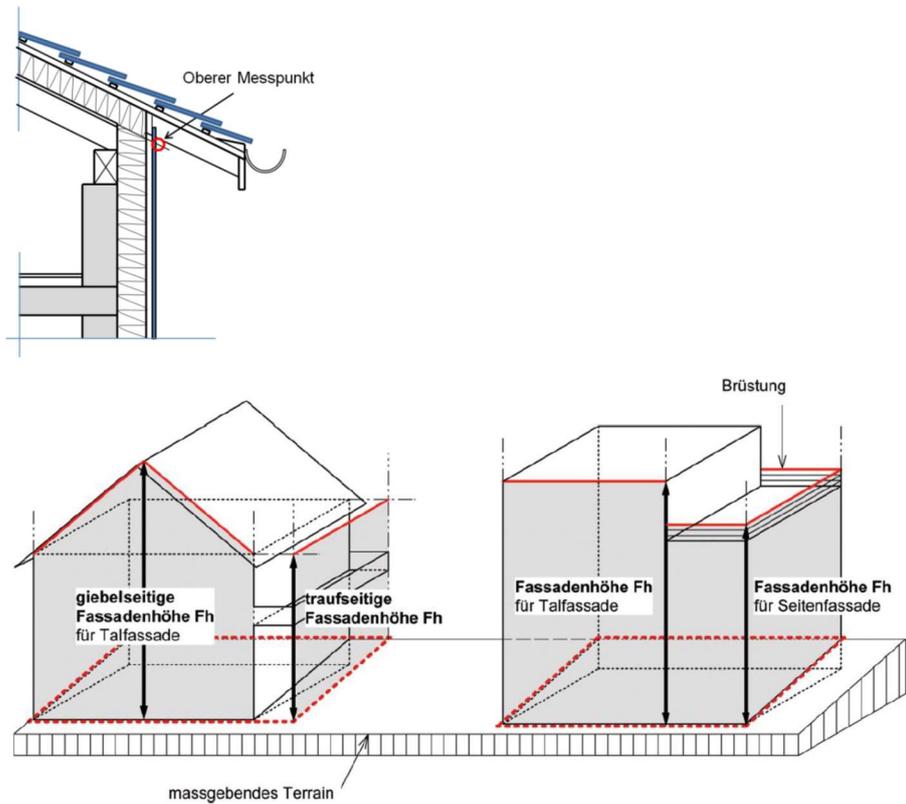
Oberster Messpunkt, traufseitige Fassadenhöhe
